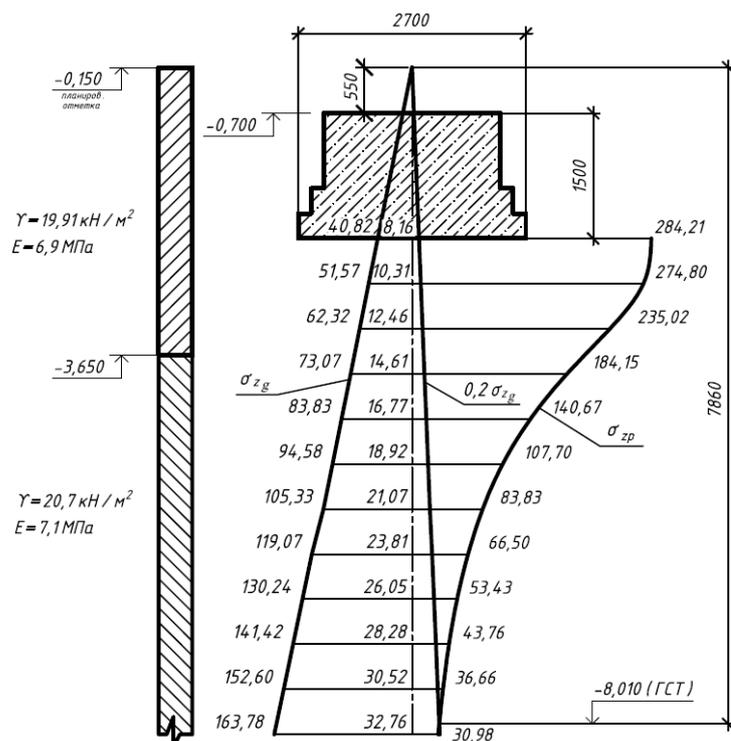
Расчетная схема распределения напряжений в основании фундамента
